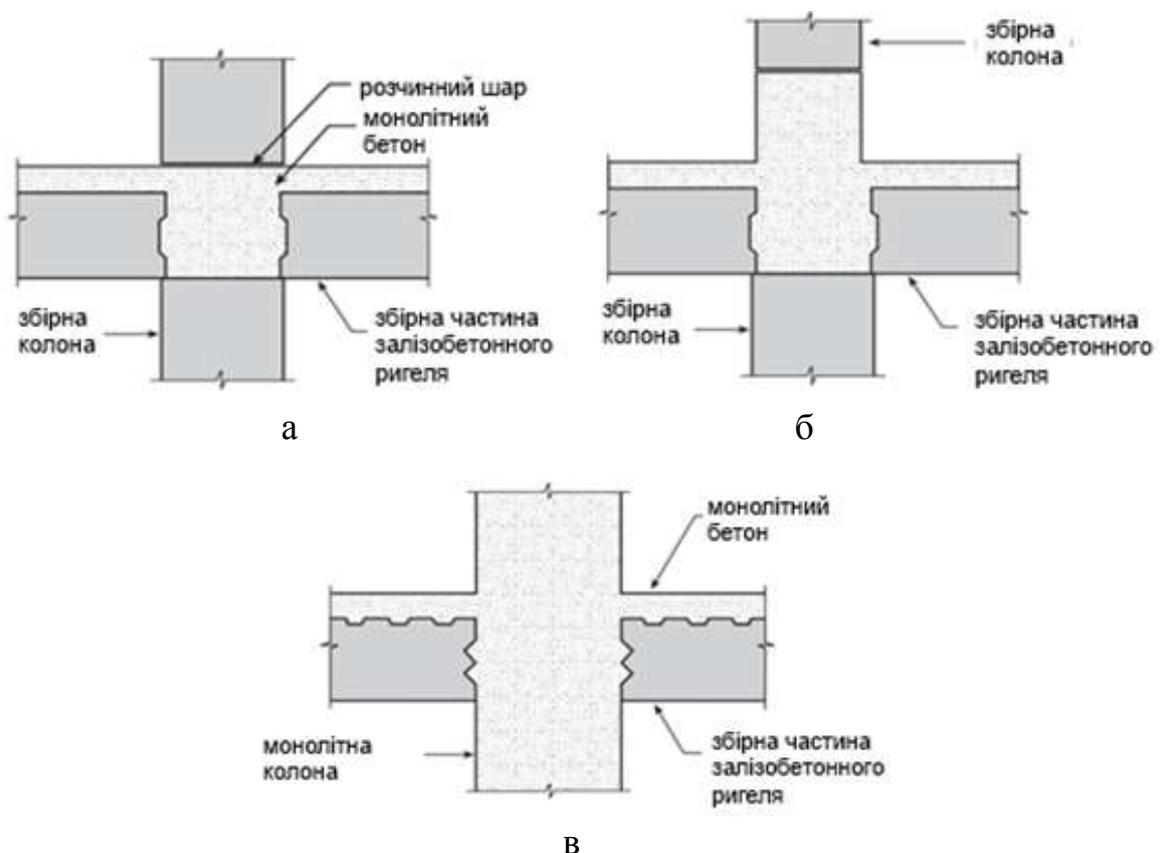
Варіанти шпонкового стику збірного елемента ригеля з колоною та монолітною частиною перекриття [1]
